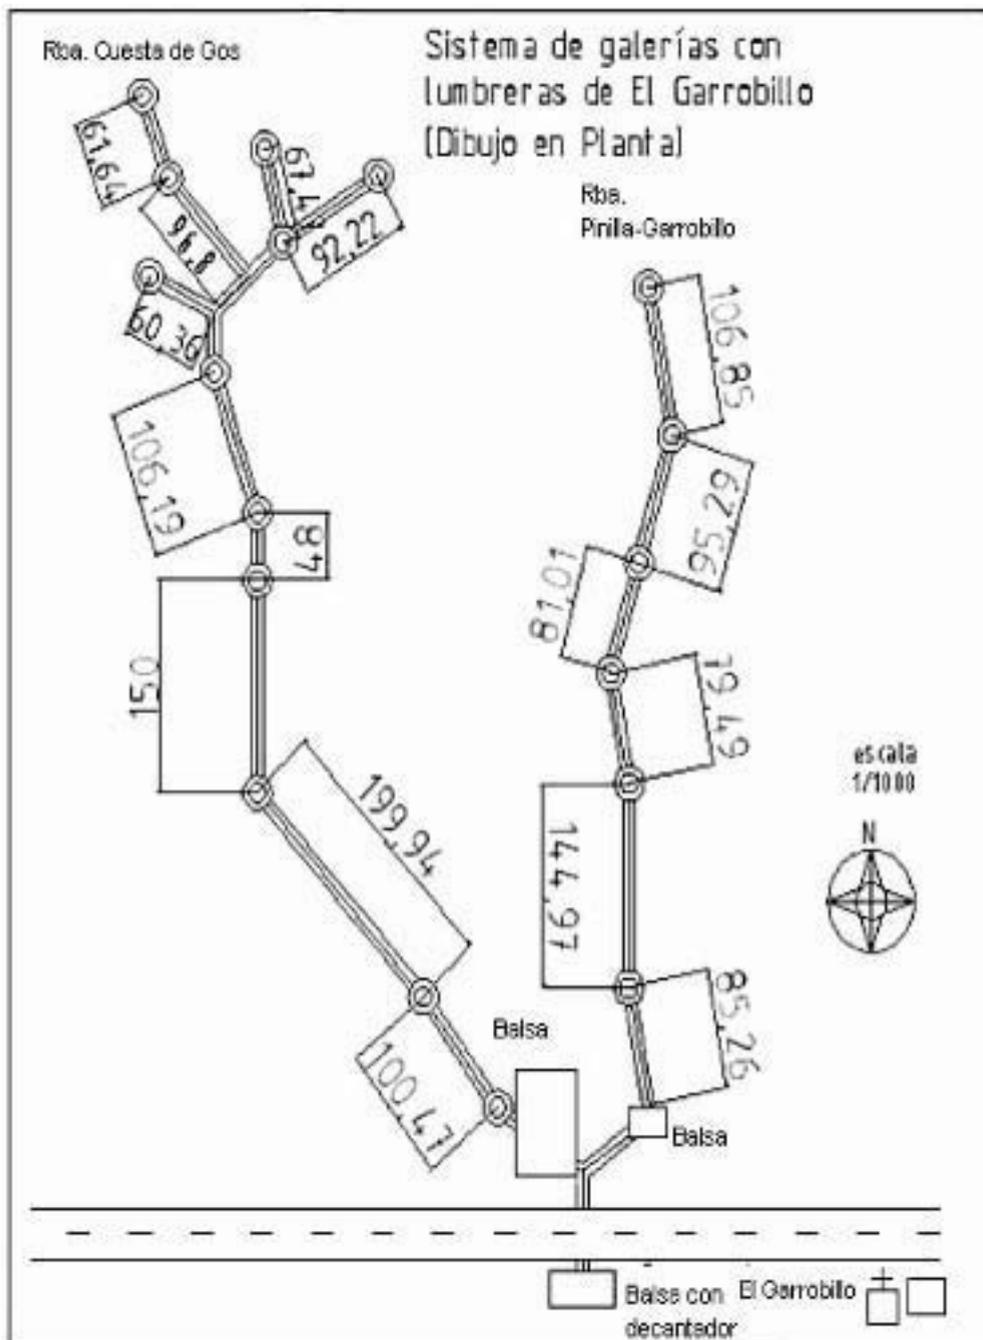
Dibujo en planta del sistema de galerías con lumberras en El Garrobillo.
